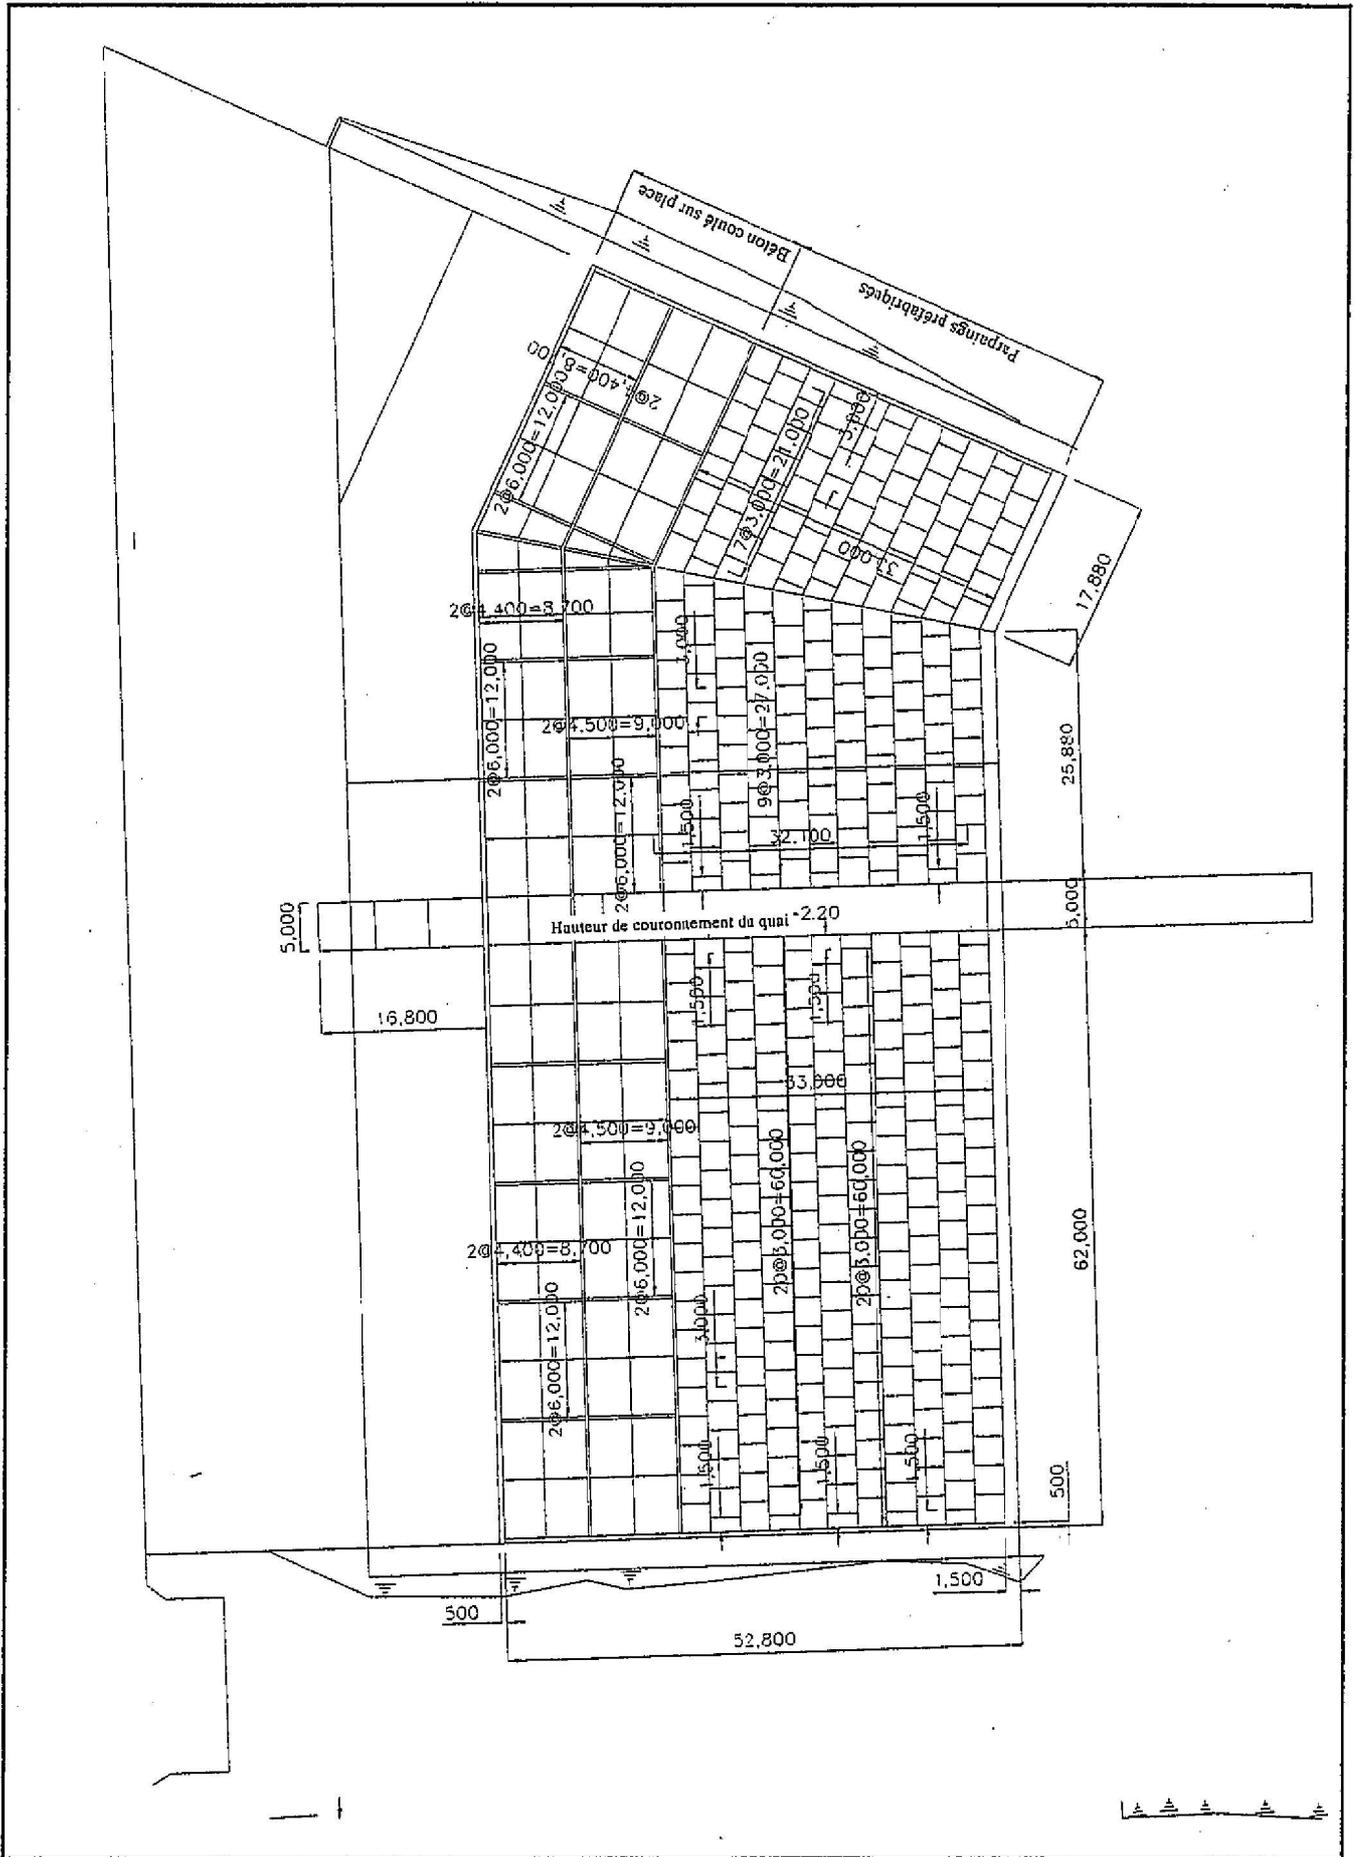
Plan planimétrique du slipway et du dépôt de pirogues
